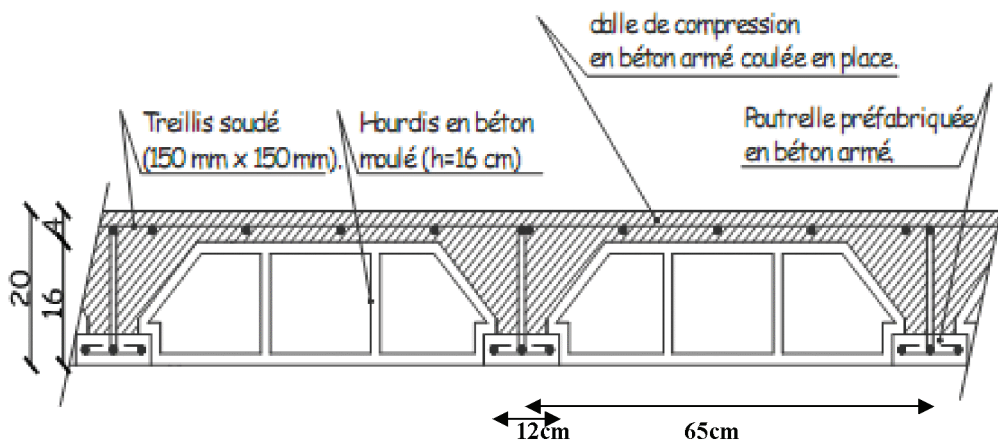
Schéma descriptif d'un plancher en corps creux.
